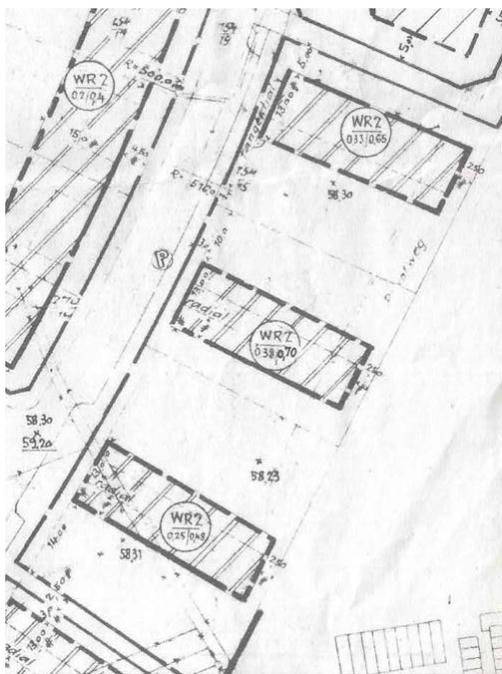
B-Plan Nr. 14 „Weinligstraße“
